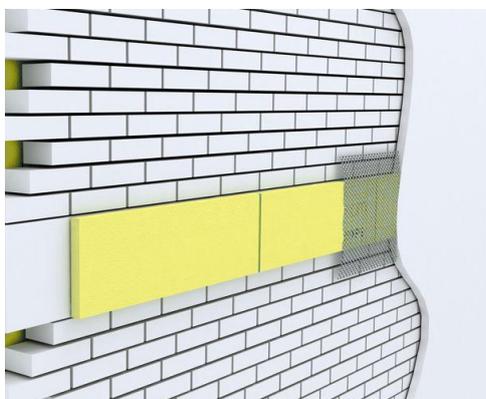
Detalle de instalación XPS en el exterior de fachada
